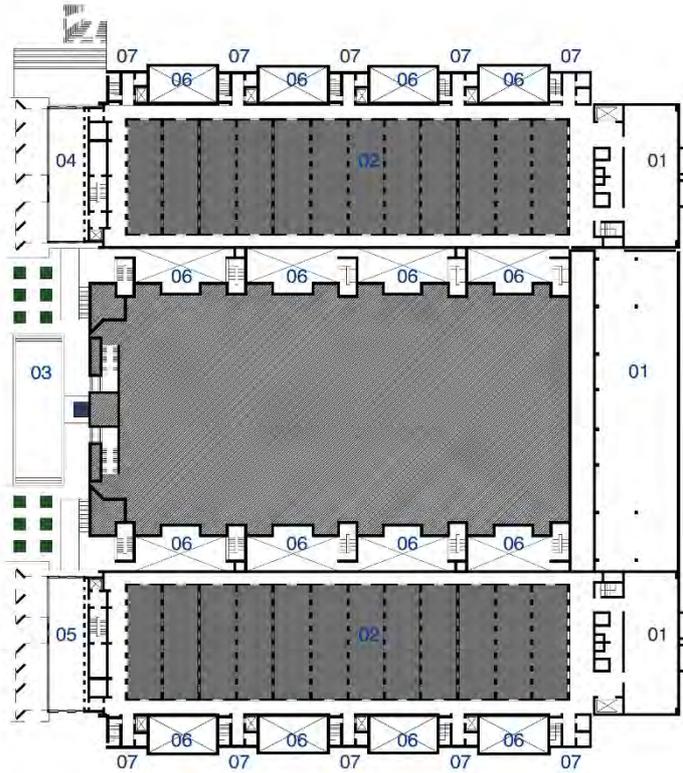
| Planta nível -1 (TERRAÇO E CAFETERIA) [redesenho do autor]
